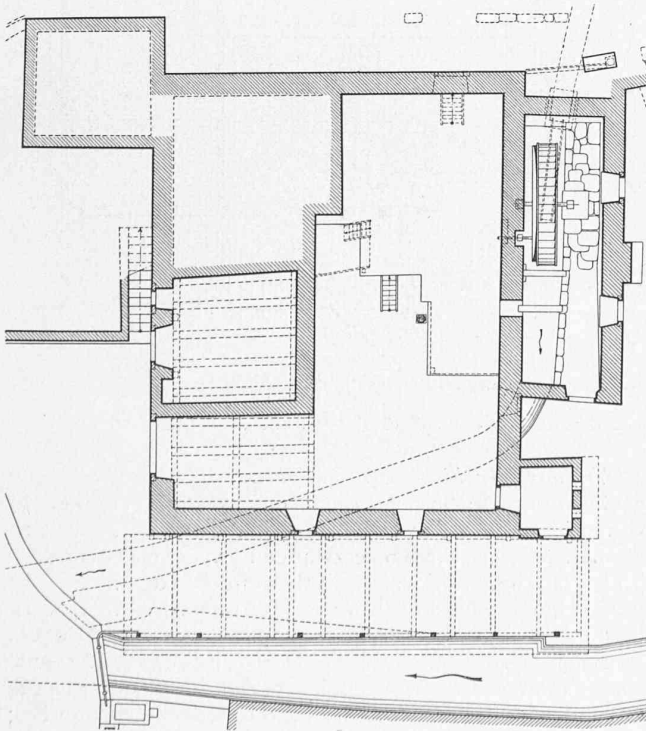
Grundriss vom Kellergeschoss.
